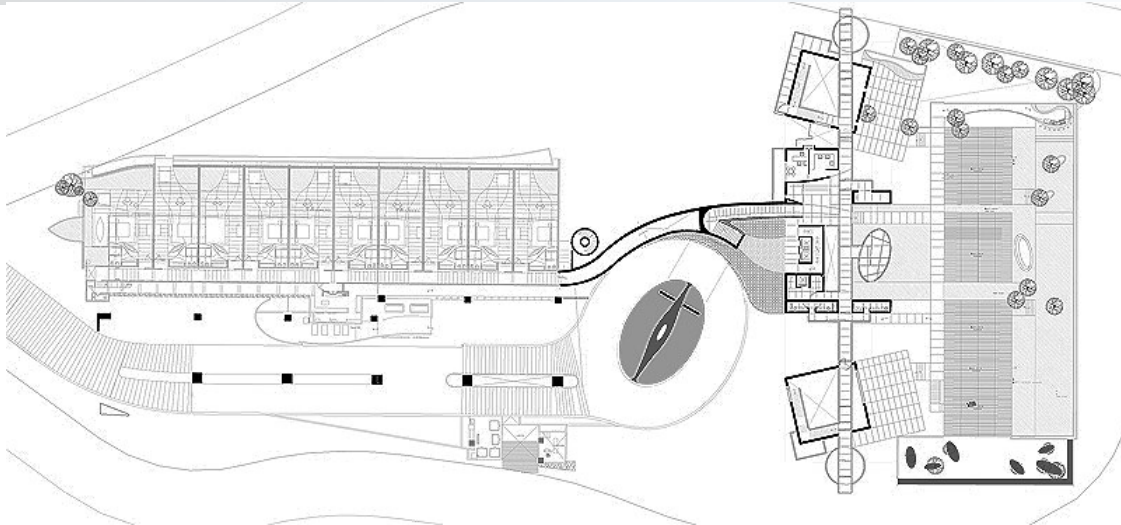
Planta Arquitectónica de Conjunto, Hotel Encanto Acapulco, 2010, Fuente: encantoacapulco.mx
